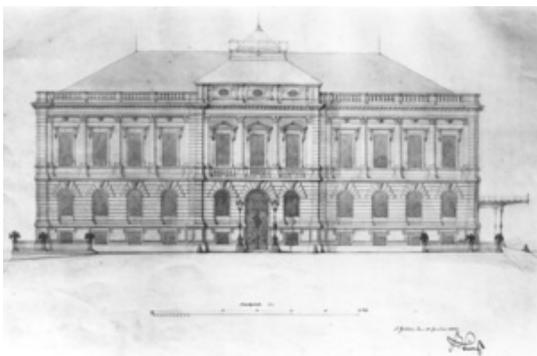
Glarus, Regierungsgebäude, Plan 5, Aufriss Hauptfassade, Vorprojekt, 1862
